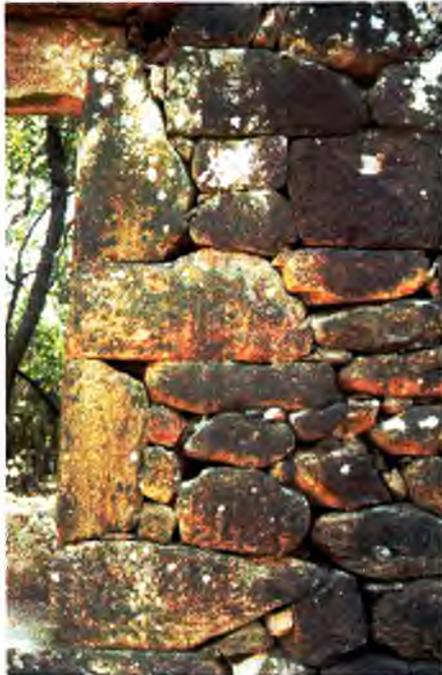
Edificação principal - Detalhe de parede em junta-seca
